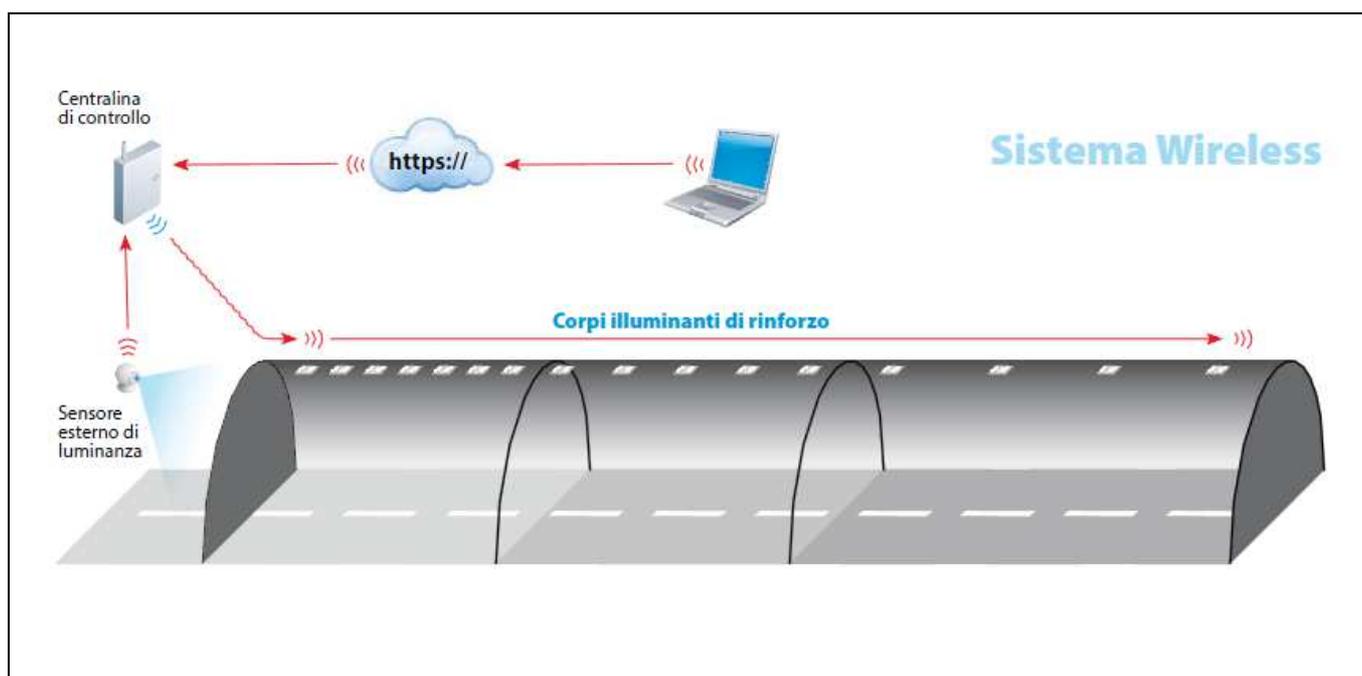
Impianto di illuminazione wireless con proiettori a led [84]
